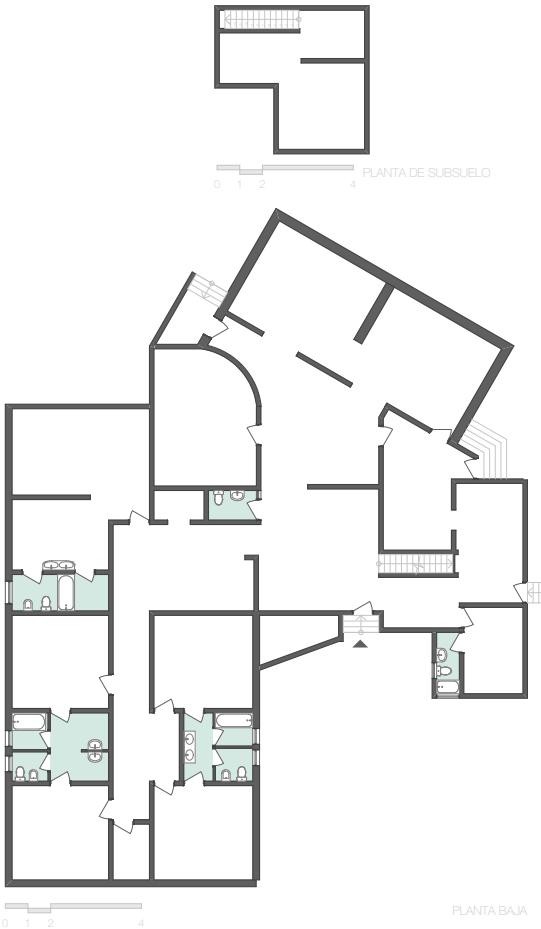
Redibujo Plantas Arquitectónicas Caso 3
